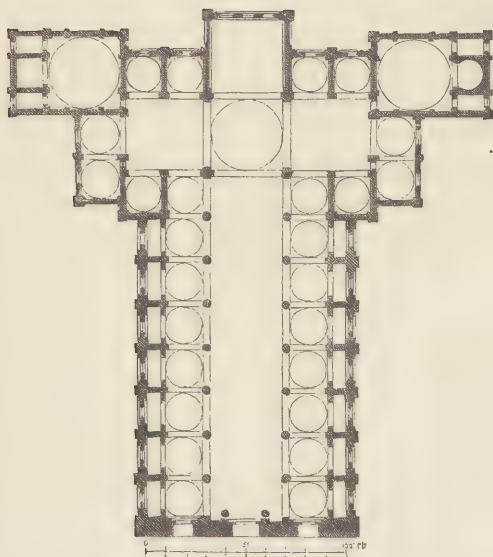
S. Lorenzo zu Florenz. Grundriss.
